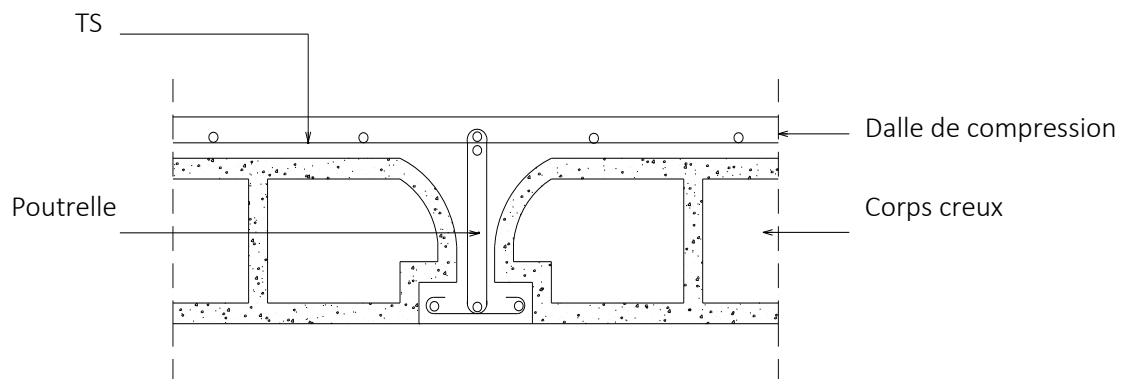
Coupe transversale d'un plancher à corps creux
